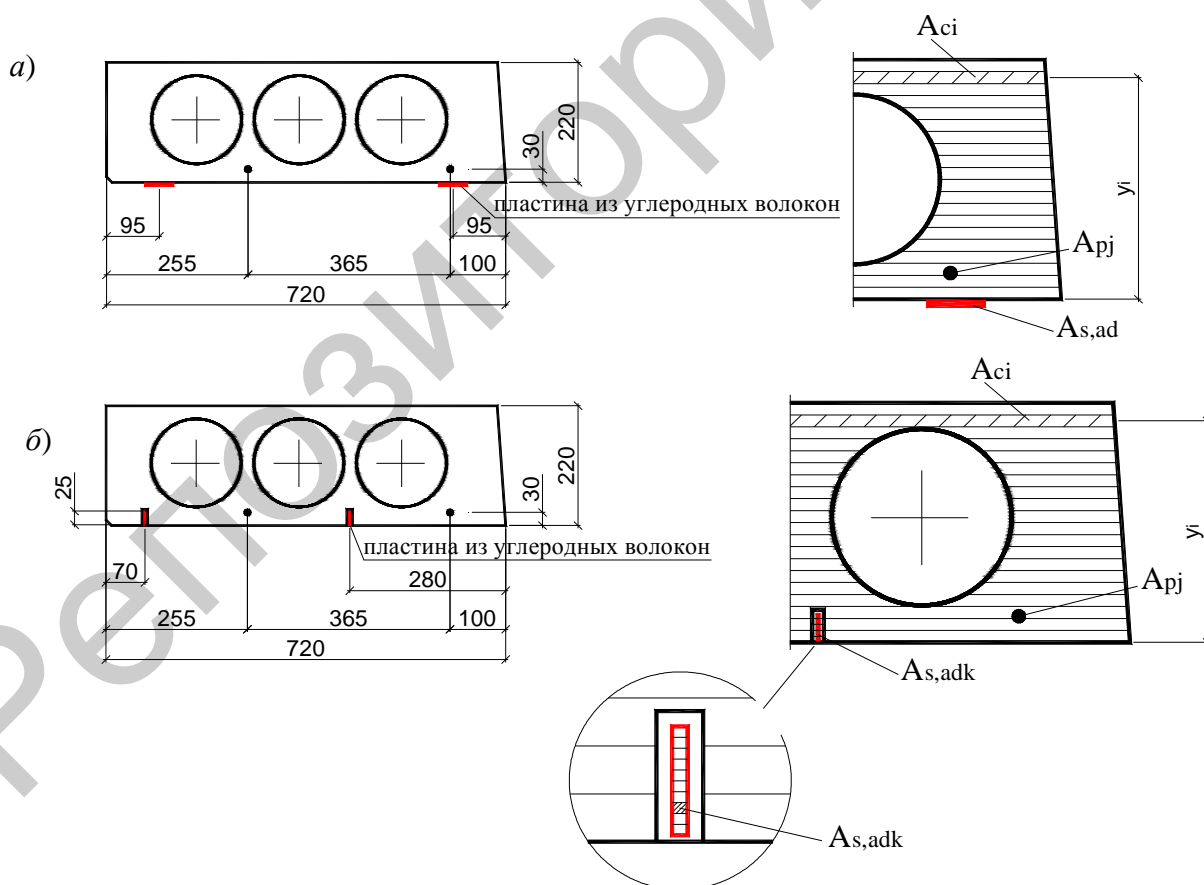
Расчетная модель нормального к продольной оси сечения многопустотной плиты, усиленной арматурой из углеродных волокон приклеиванием к наружной поверхности бетона (а), вклеиванием в пазы (б)
